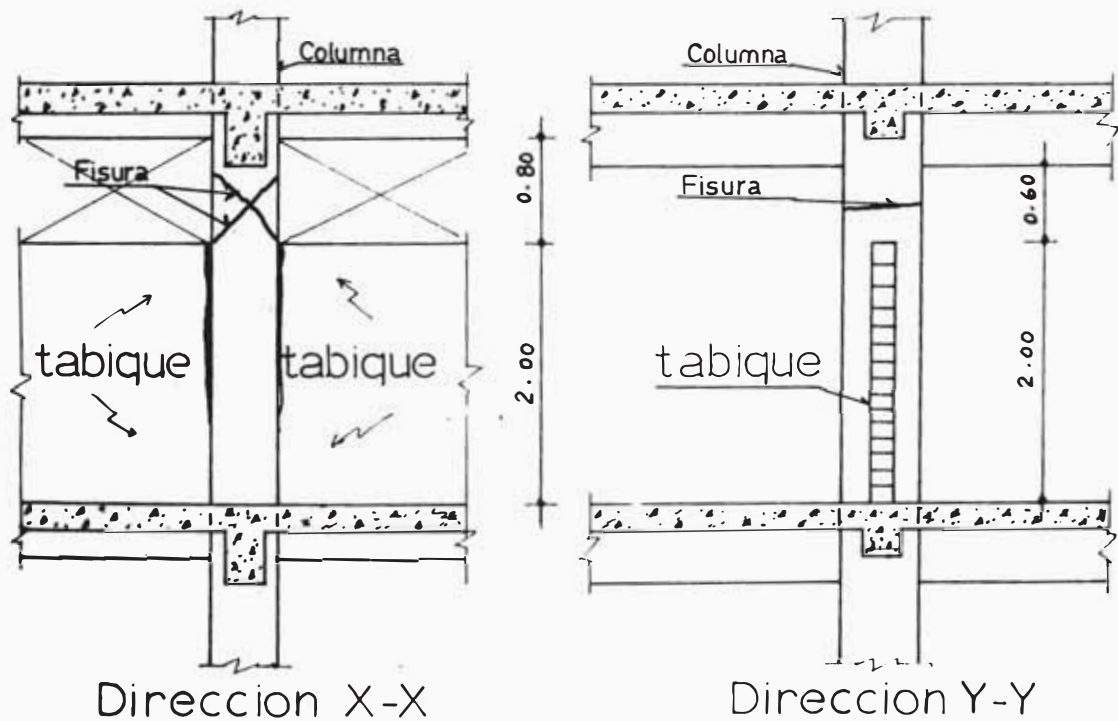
Fisuras en columnas arriostradas. (columnas "cortas") en entrepisos intermedios y en zona de ventanas altas
